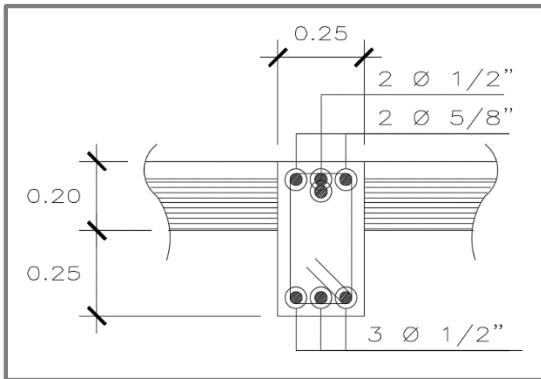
Detalle del acero longitudinal de la Viga 25X45-corte 1-1
